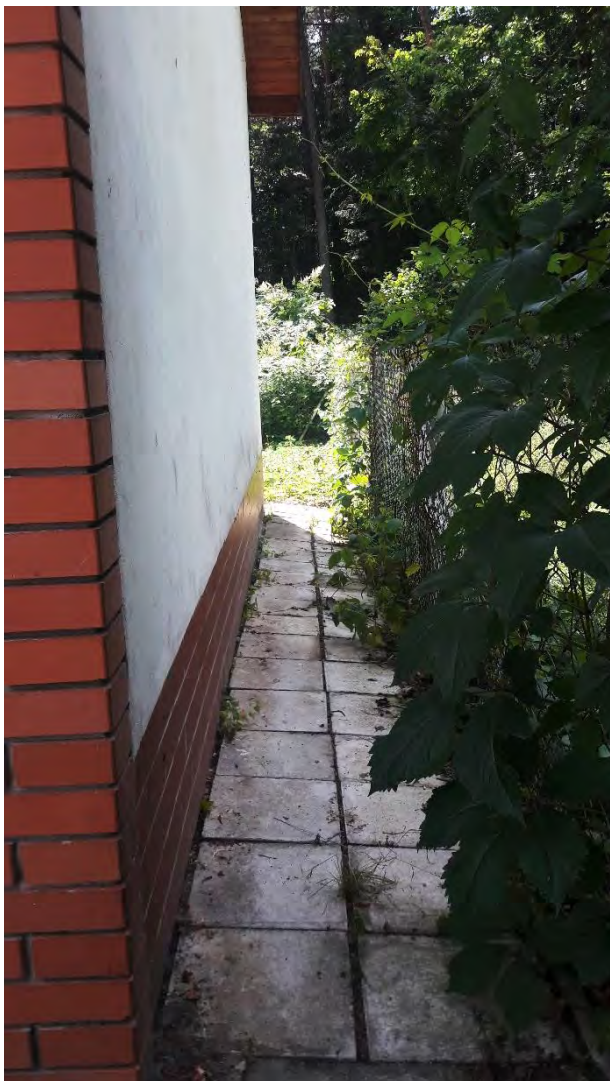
Elewacja tylna i boczna - widok od strony zachodniej
